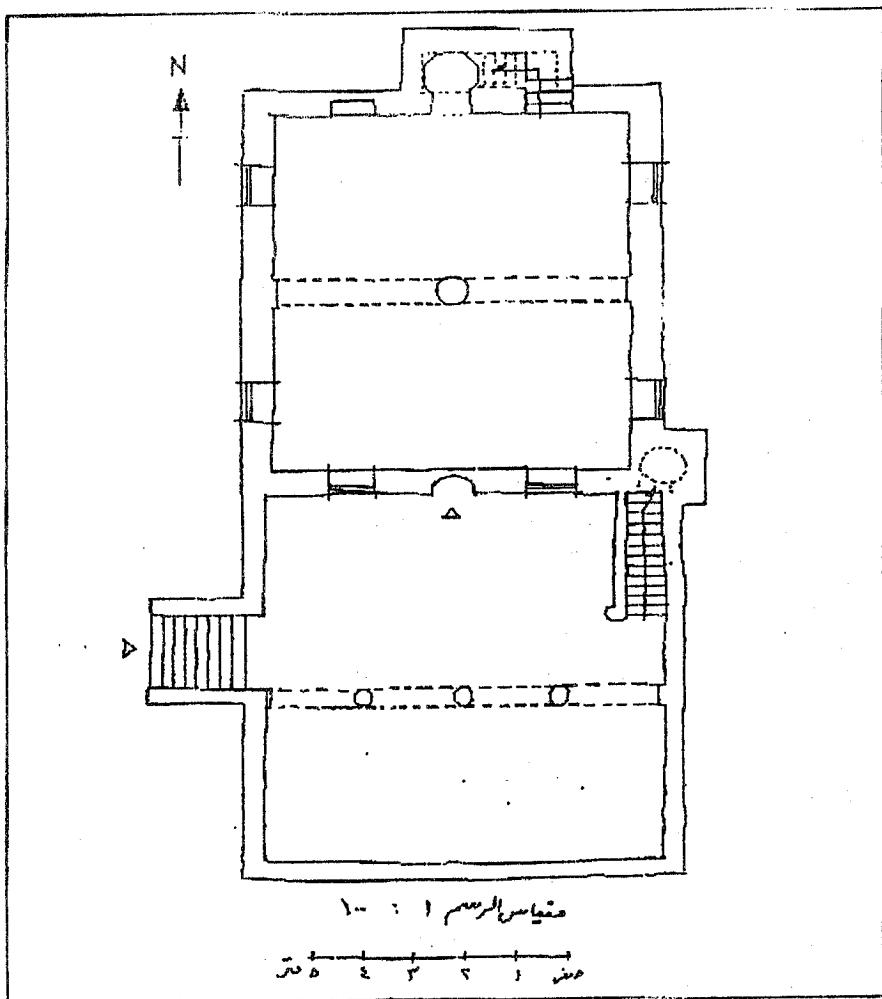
مسقط أفقي لجامع فخر الدين (عن Horton E., ٢٠٠٧).
